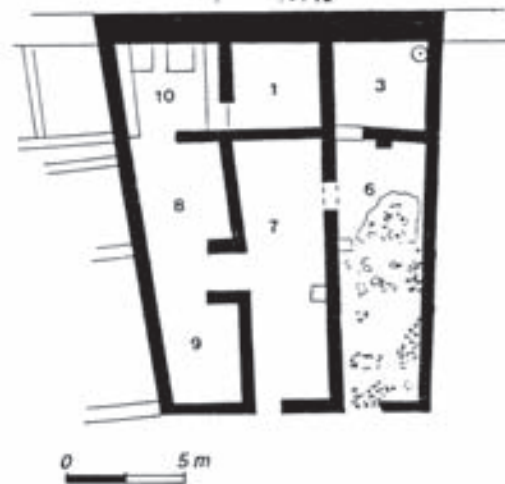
Planta i reconstrucció d'una gran casa documentada a La Seña.
